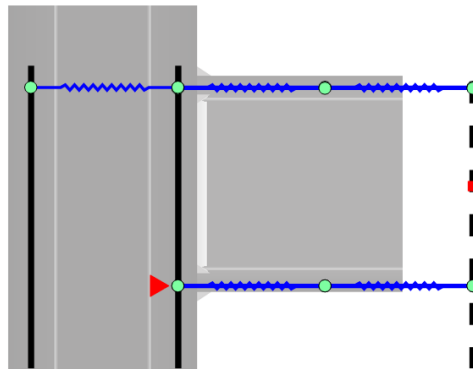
Assemblagem esquemática de disposição de molas em ligações SP
